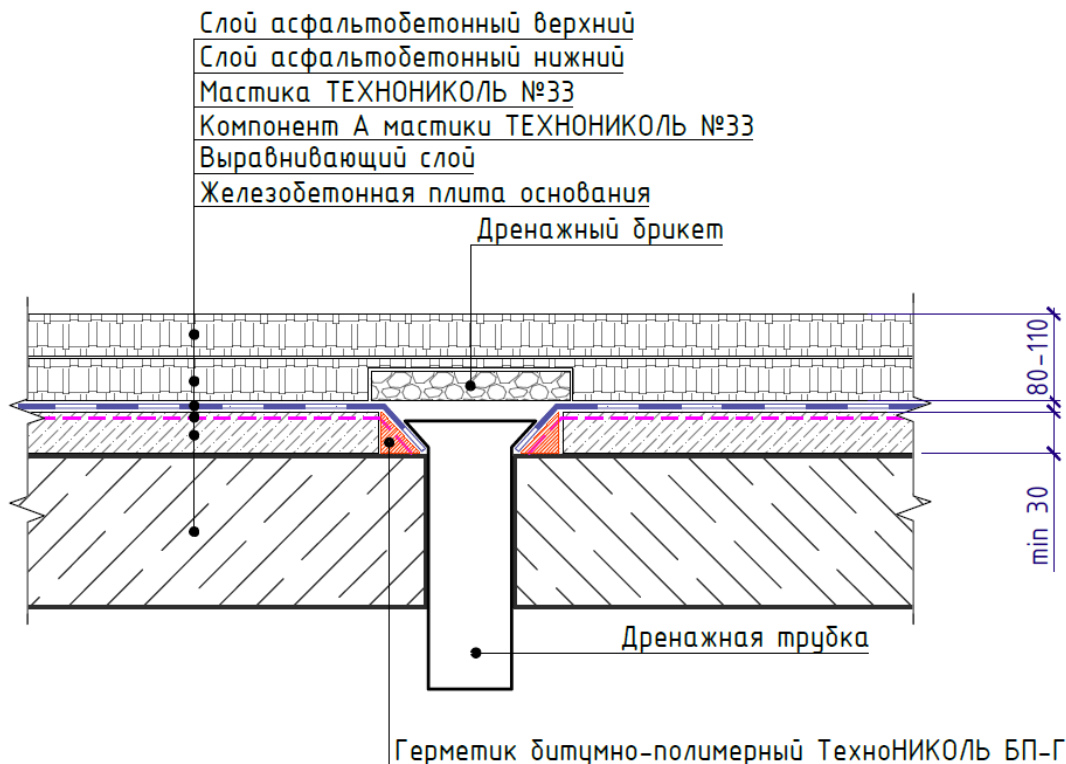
конструкция сопряжения гидроизоляции с дренажной трубкой
